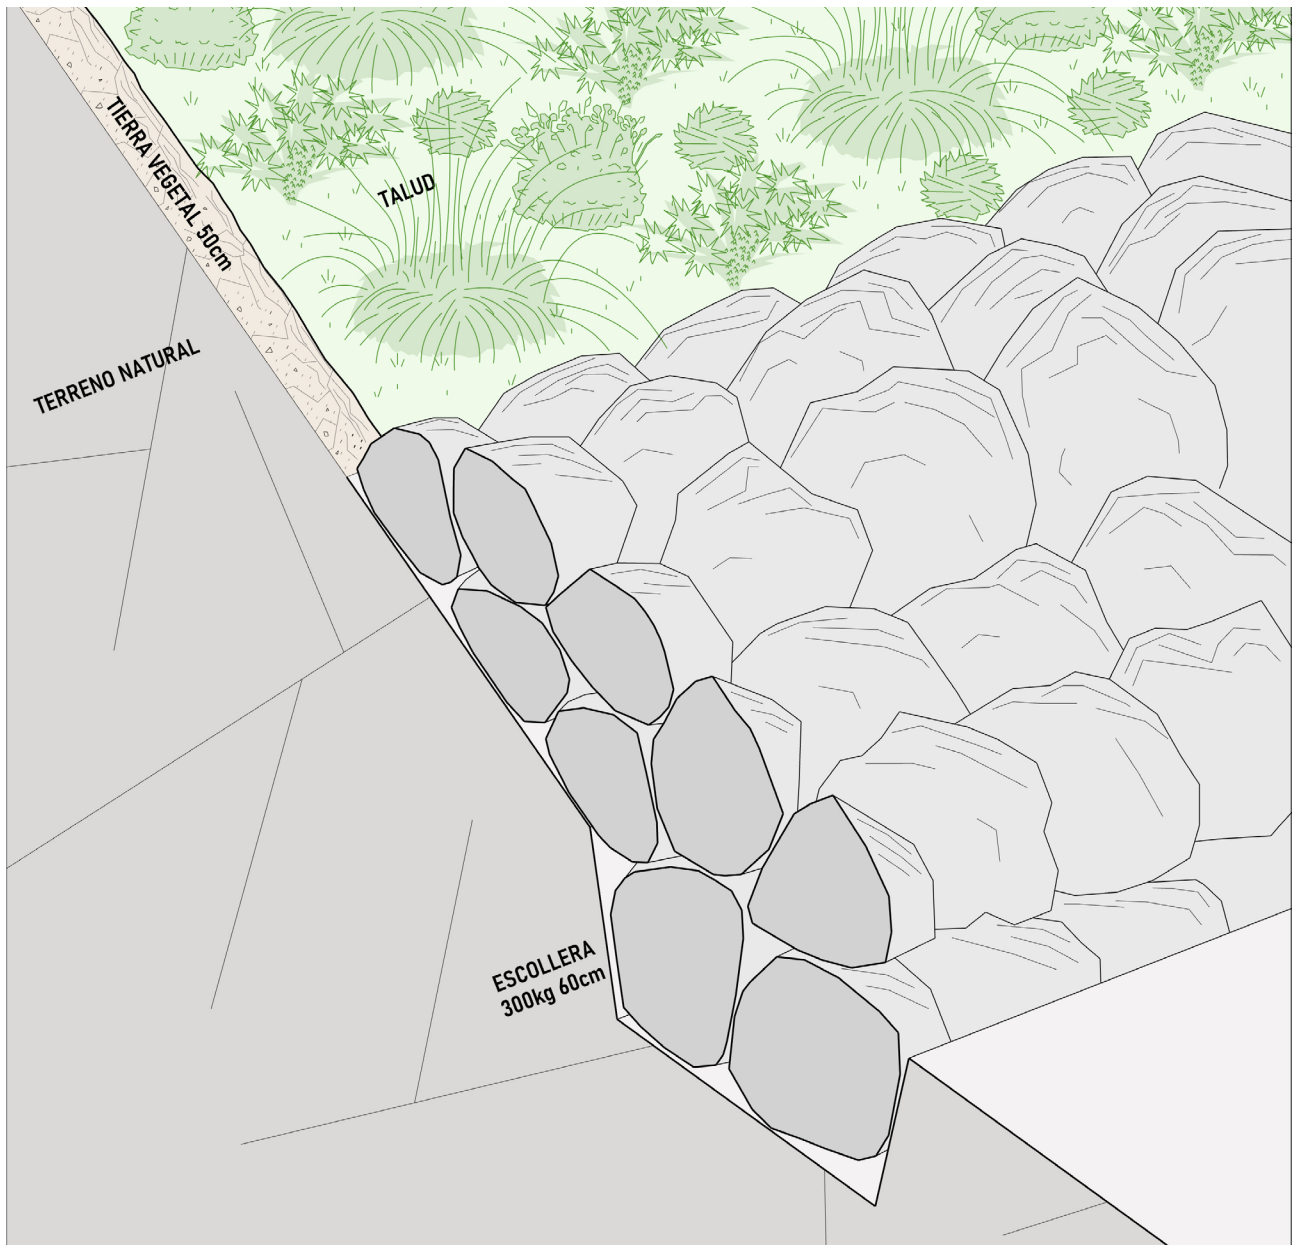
Refuerzo de escollera apoyada en pie de talud.
